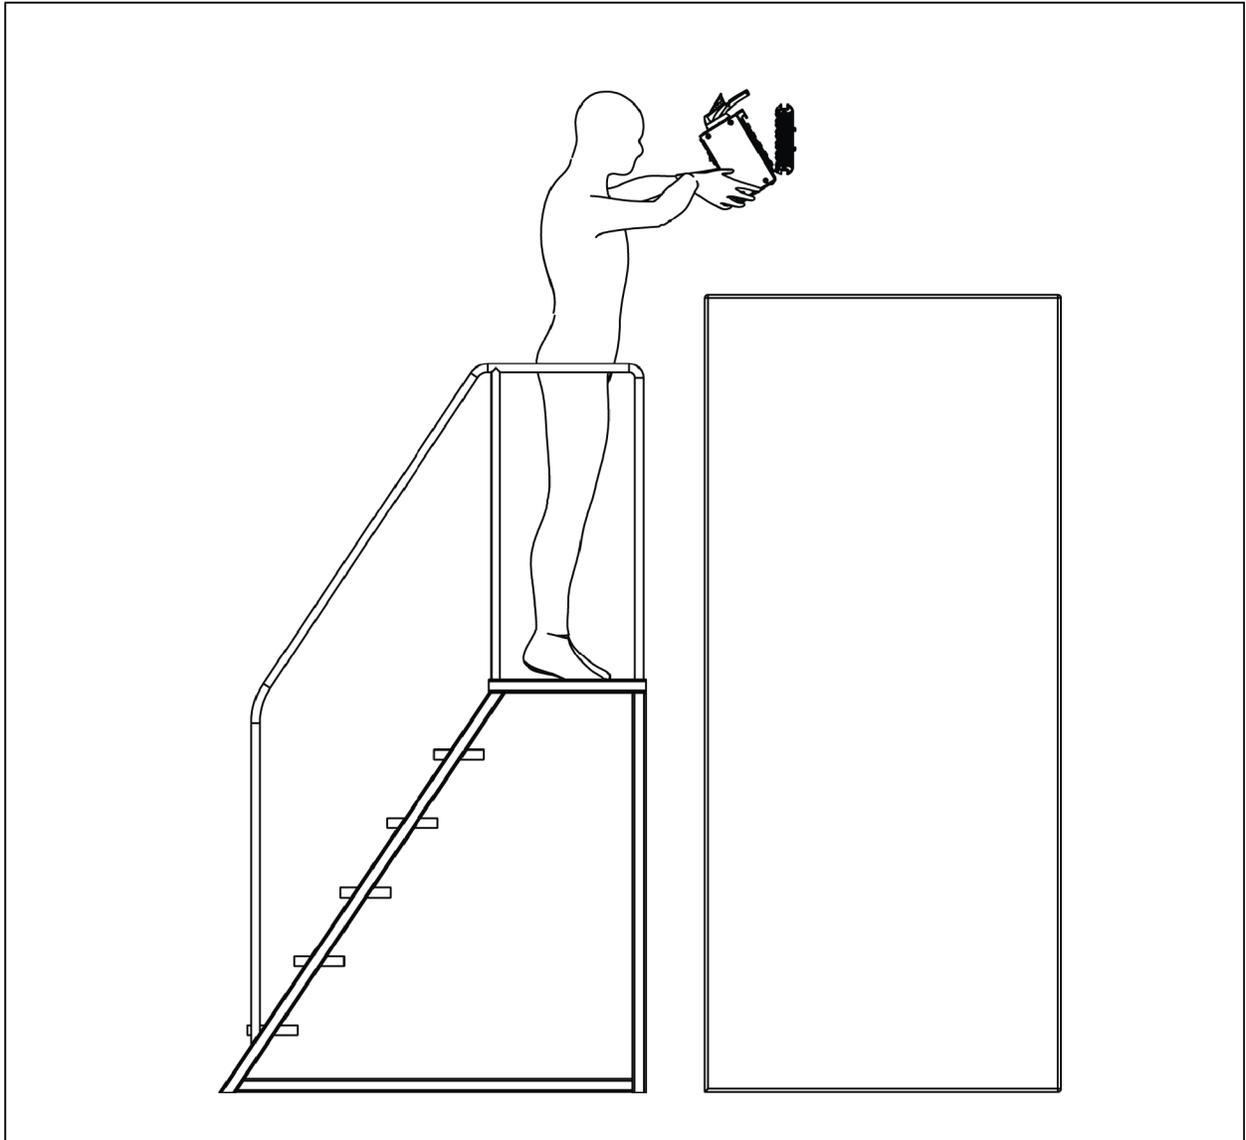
Esempio di installazione della cassetta di derivazione: sopra il rack con impianto doppio di blindosbarra verticale, impilati
